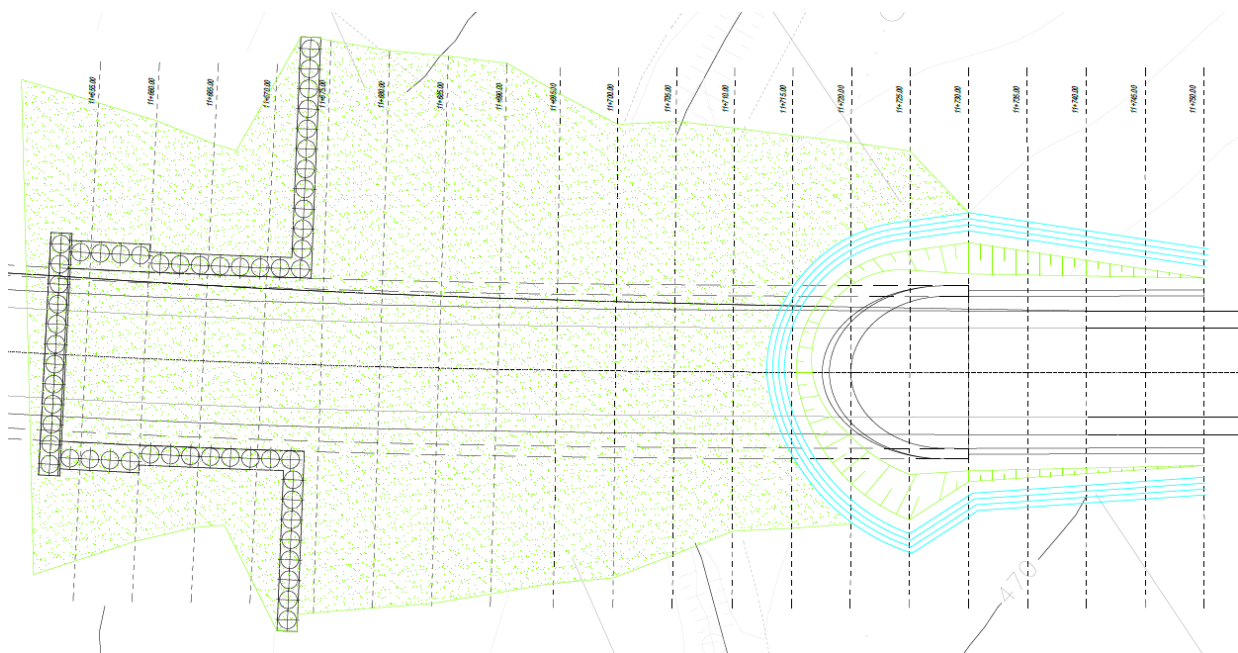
Stralcio planimetrico imbocco B (Lato Sud)
